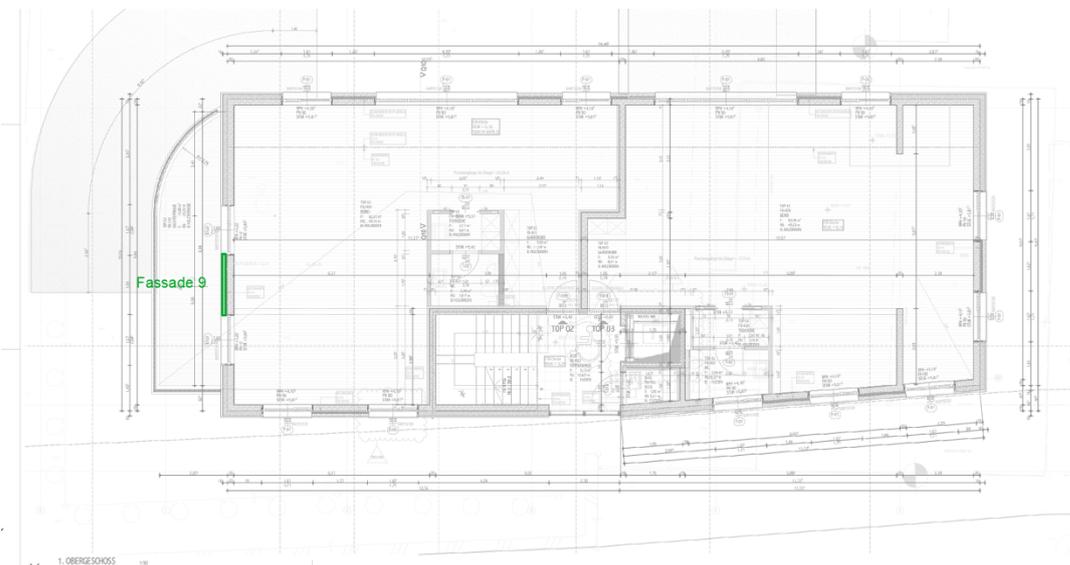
Planliche Darstellung der Fassade 9 im 1. Obergeschoß
